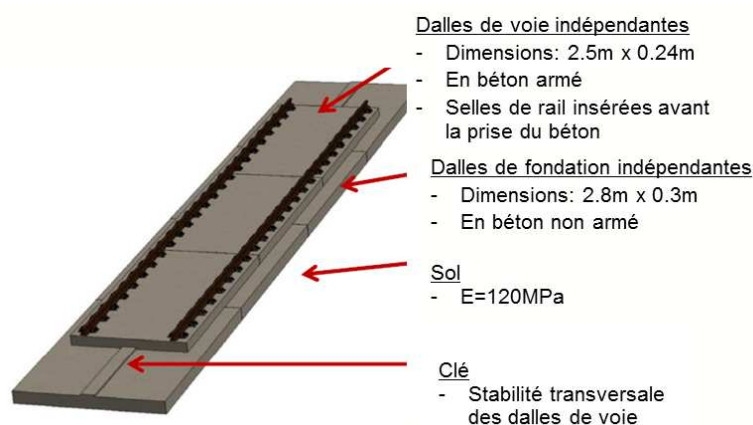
Schéma de principe de la voie ferroviaire sur dalles en béton conçue dans le cadre du projet FUI NBT
